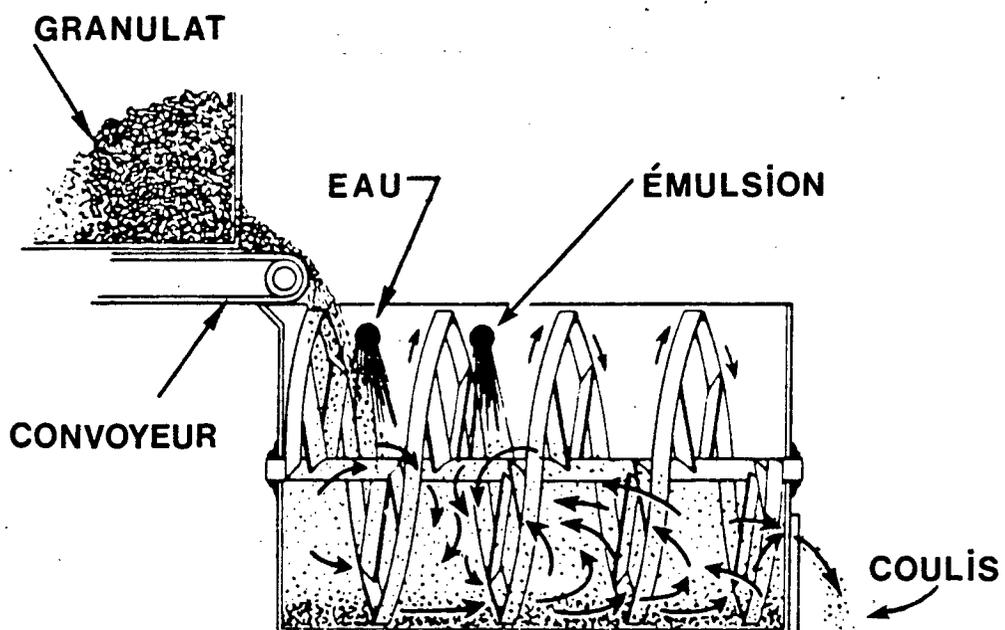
Préparation du coulis de scellement dans la machine illustrée à la figure 6.
